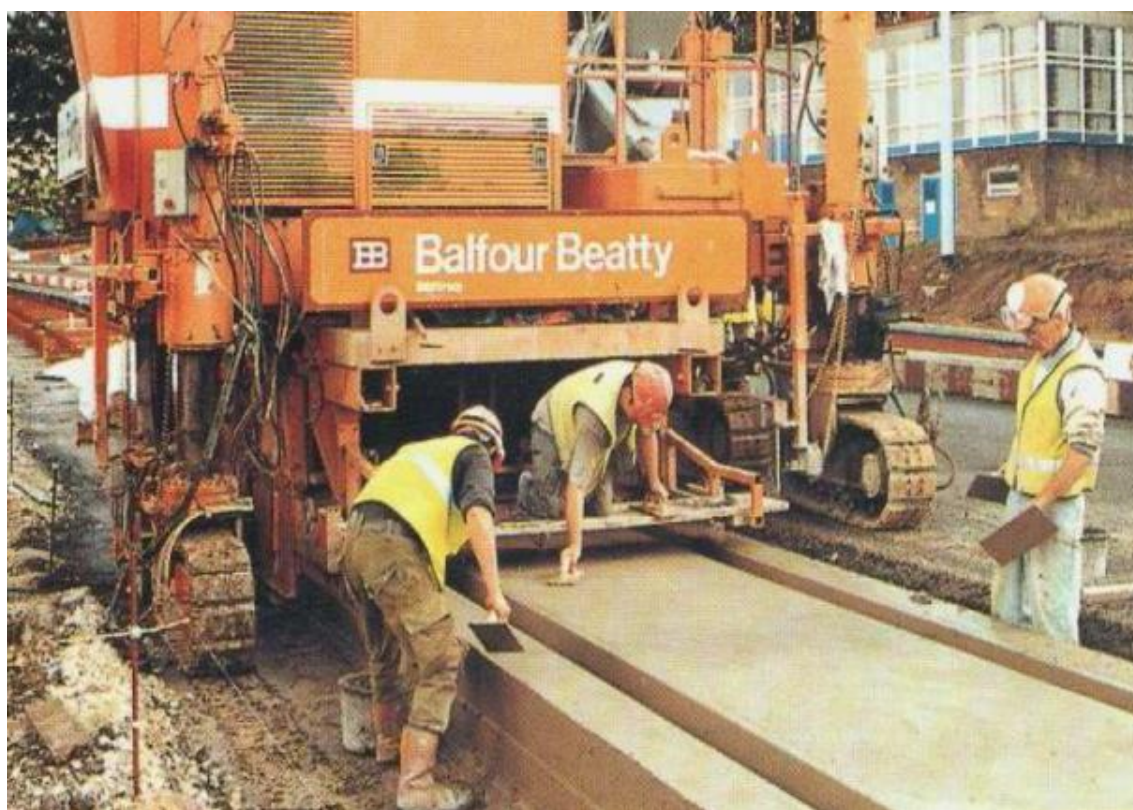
Execução da laje com sulcos longitudinais para instalação dos carris (Penny, 2003)
